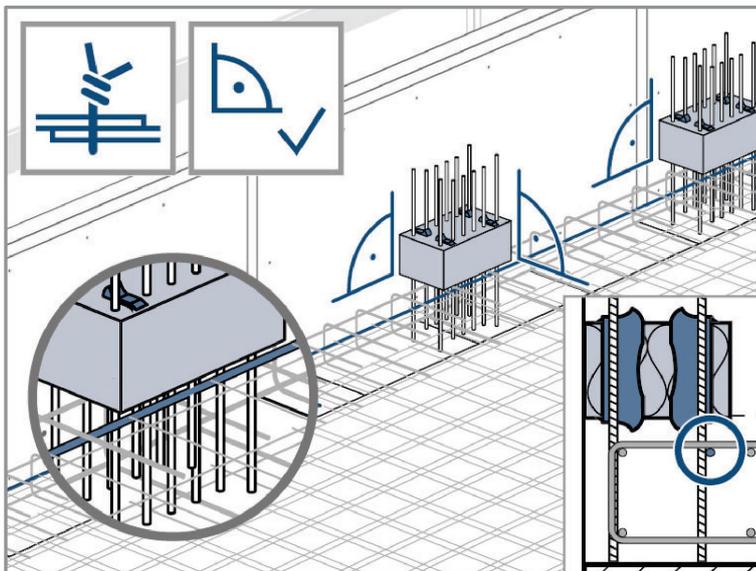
Installation Isokorb® CXT Typ A mit Combar® Zugstäben: Direktes Aufsetzen auf der Deckenschalung sowie Lagefixierung
